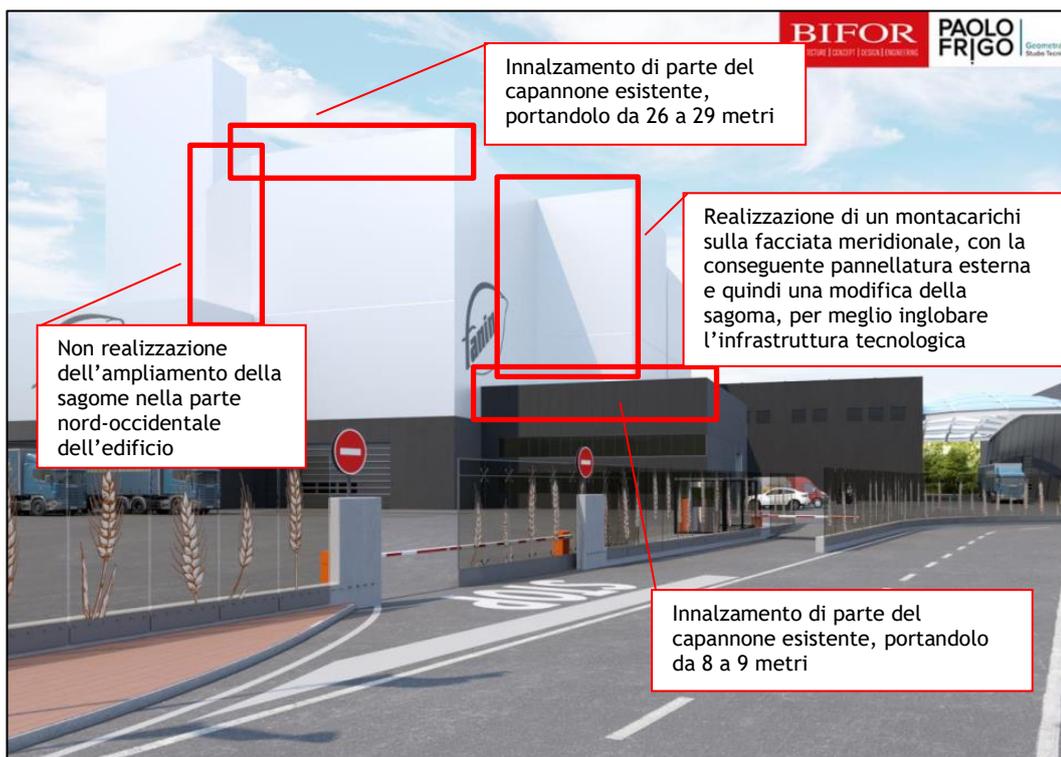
DEFINIZIONE DELLE MODIFICHE PROPOSTE SU FOTOINSERIMENTO
